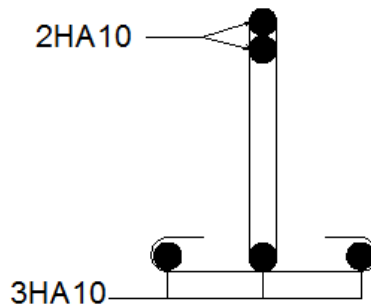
Ferrailage de la poutrelle en appuis.
